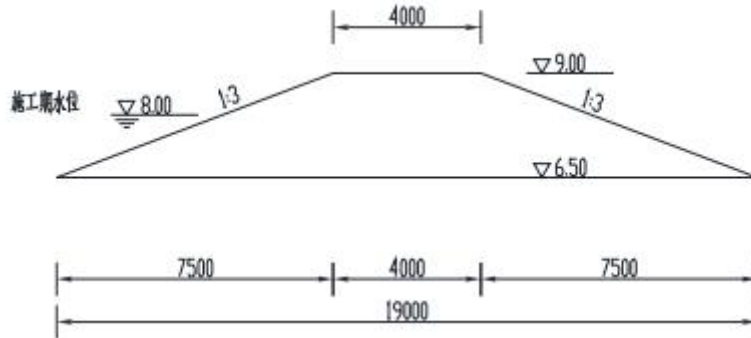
2#拦河围堰断面图 (单位: mm)
